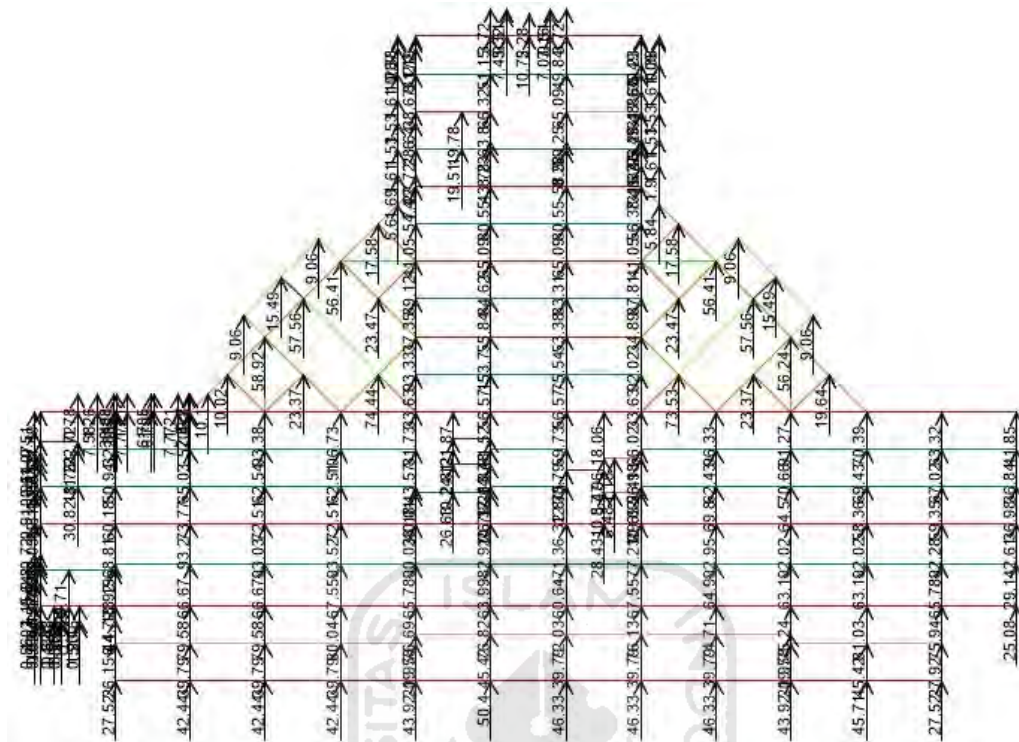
17 Gaya Joint Load Fpx Arah Y pada Lantai 2
